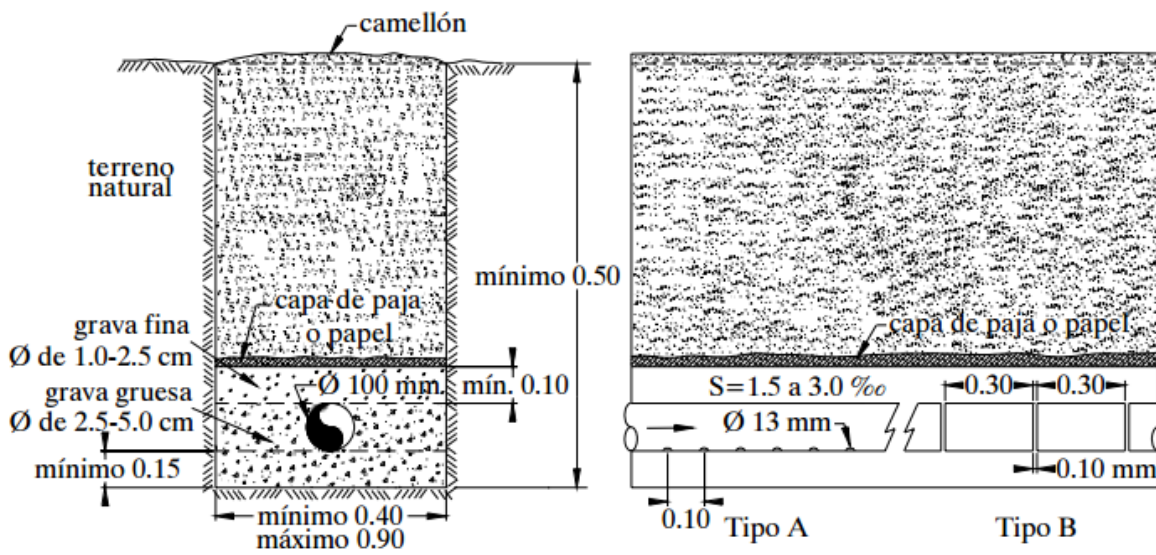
Zanja de infiltración Construido in-situ⁴⁷
